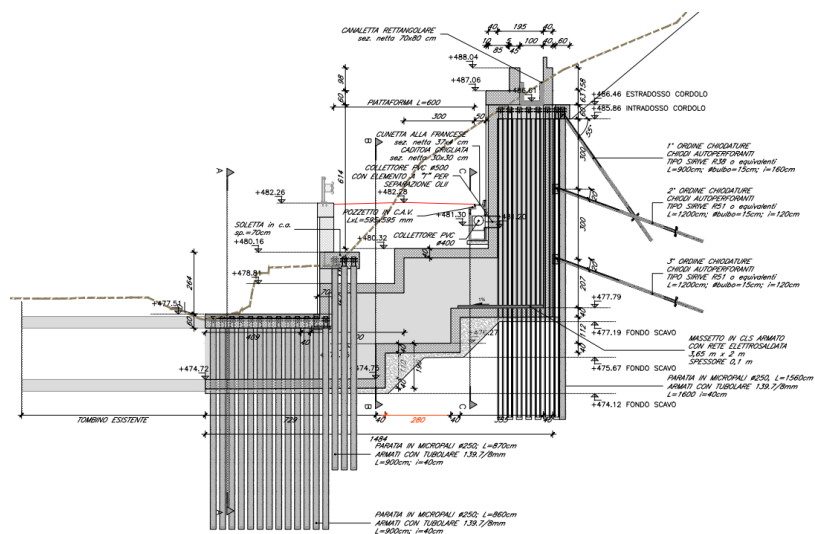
Sezione di intervento nel sublotto (vedi Elab. IBOA00EZZBZNV0960002C)
